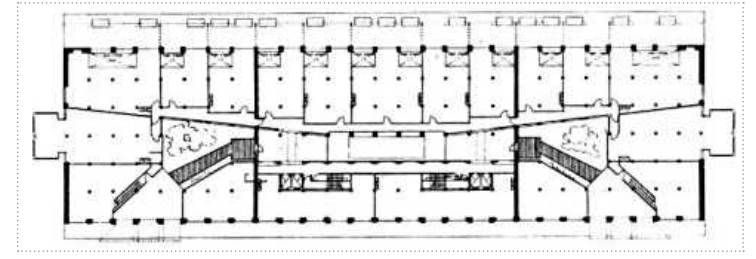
Planta pavimento térreo do Galpão 5, destinado a uso comercial e de serviços. Fonte: Revista Arquis nº 1.
